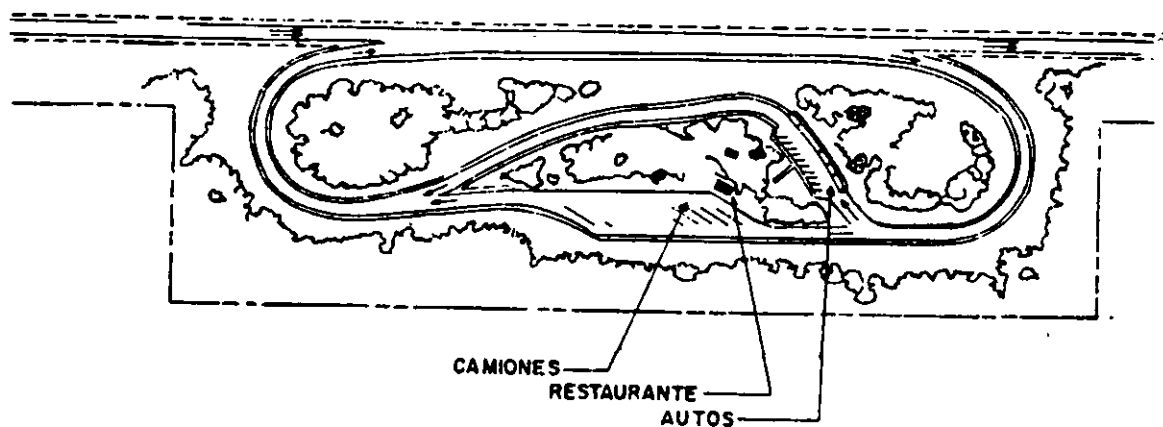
ZONA DE DESCANSO APROPIADA PARA BAJOS VOLUMENES DE TRANSITO, CON DOS AREAS SEPARADAS DE ESTACIONAMIENTO BUSCANDO NO INTERFERIR CON LA VEGETACION EXISTENTE
